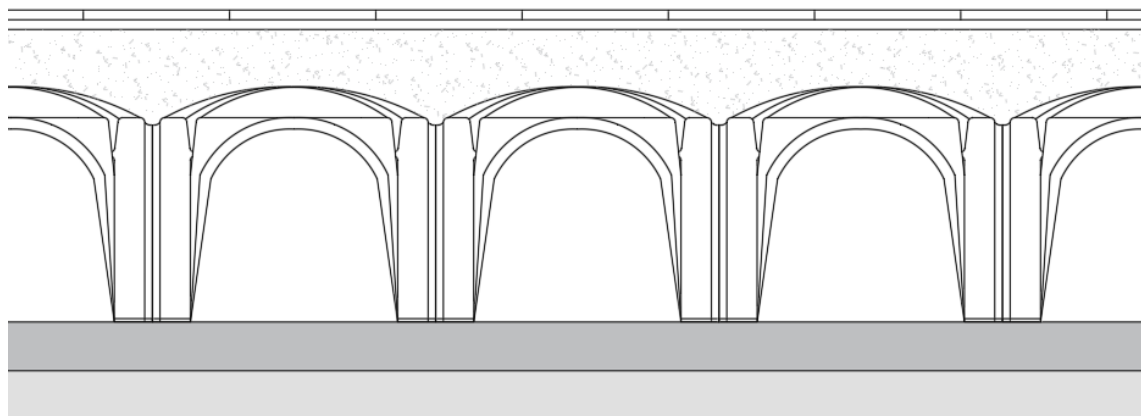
Detalle constructivo forjado sanitario. 2019. Fuente propia.
